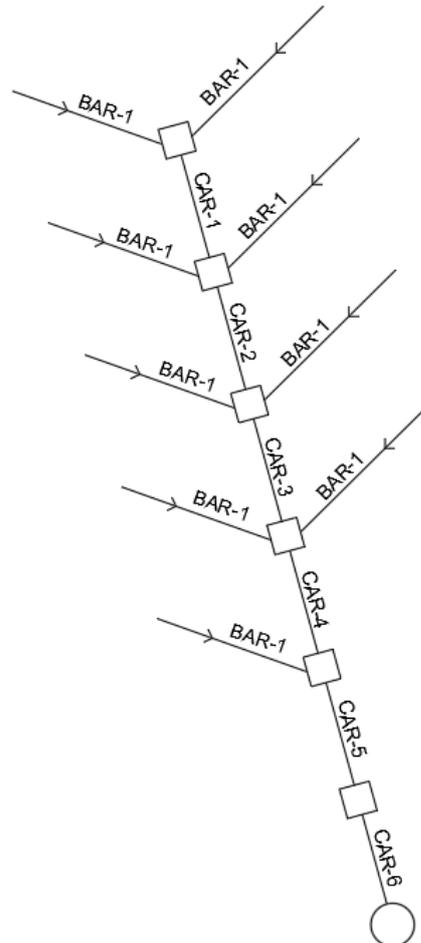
Esquema de colectores de aguas pluviales visto en planta
